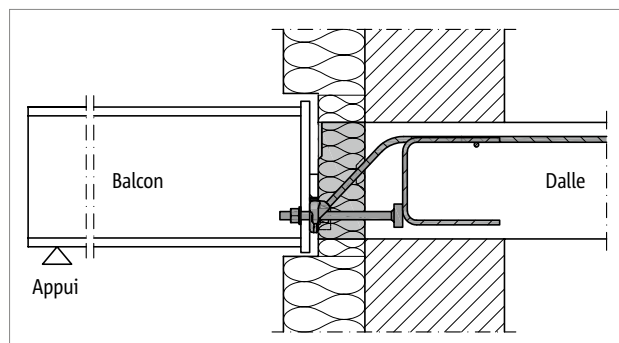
Schöck Isokorb® T type SQ : raccordement à la dalle en béton armé ; corps isolant à l'intérieur de l'isolation thermique extérieure
